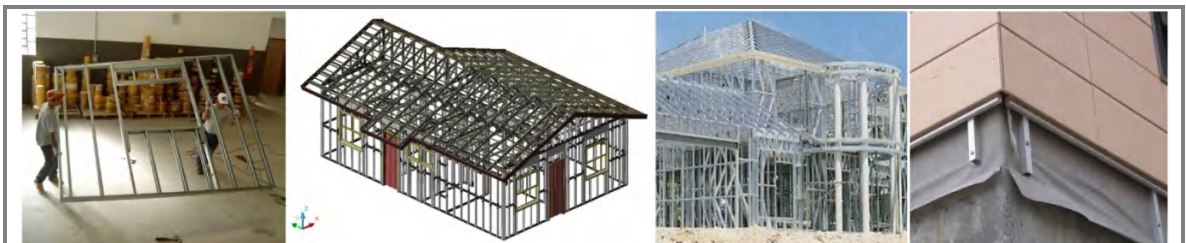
Construcciones realizadas con el sistema SteelBuilt.
